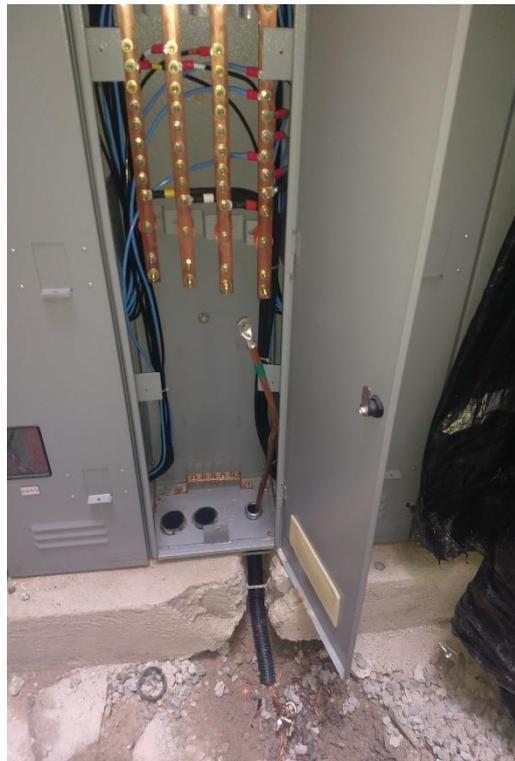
A 12: DETALHE DA EXECUÇÃO DO ATERRAMENTO SITUADO NO ESTACIONAMENTO PARA OS QM.
